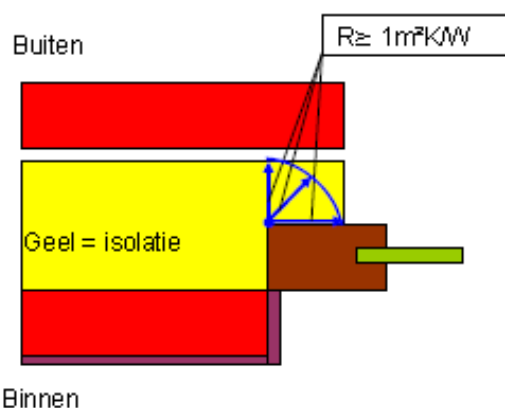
Inbouw buitenschrijnwerk horizontale snede met teruggemete dag
